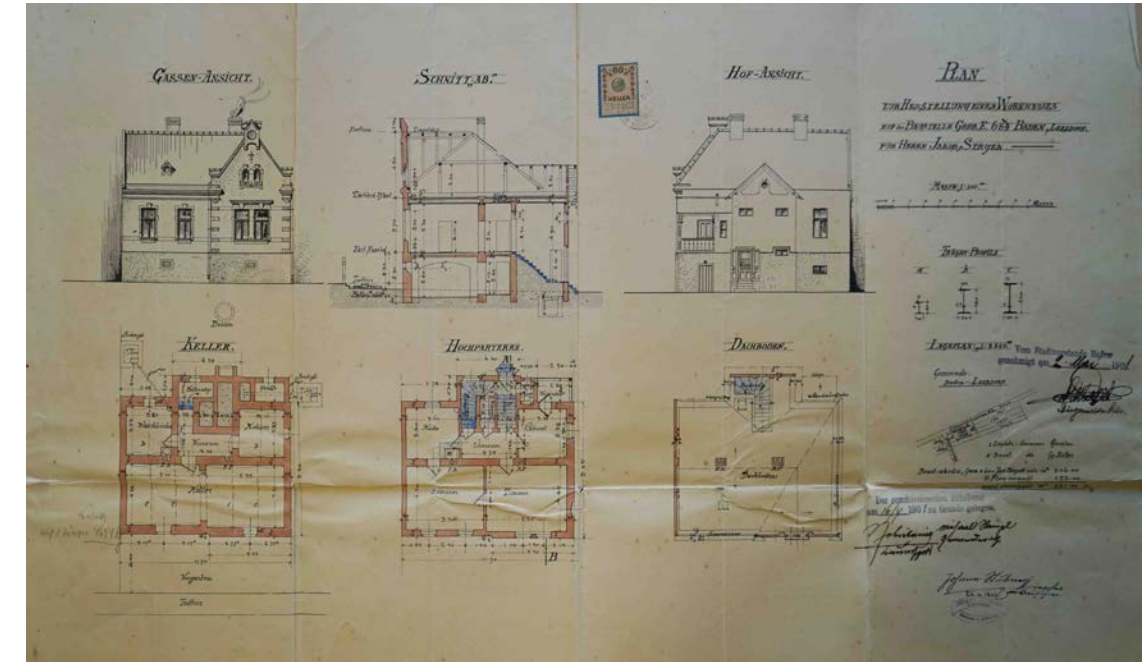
Einreichplan Germergasse 36, 25.1.1901.
